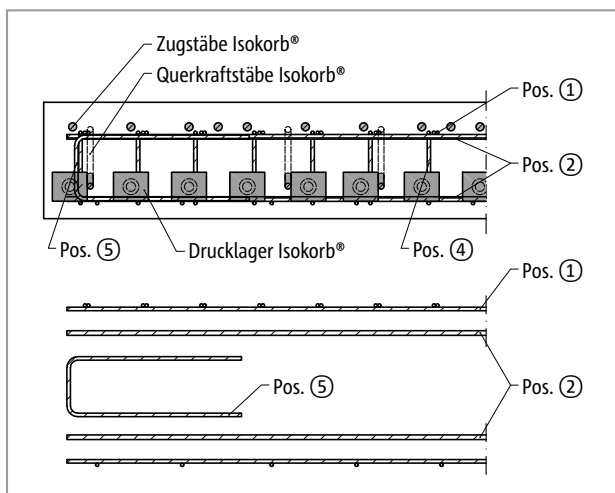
Schöck Isokorb® T Typ K-M12: Bauseitige Bewehrung balkonseitig im Schnitt A-A; Pos.5 = konstruktive Randeinfassung am freien Rand
